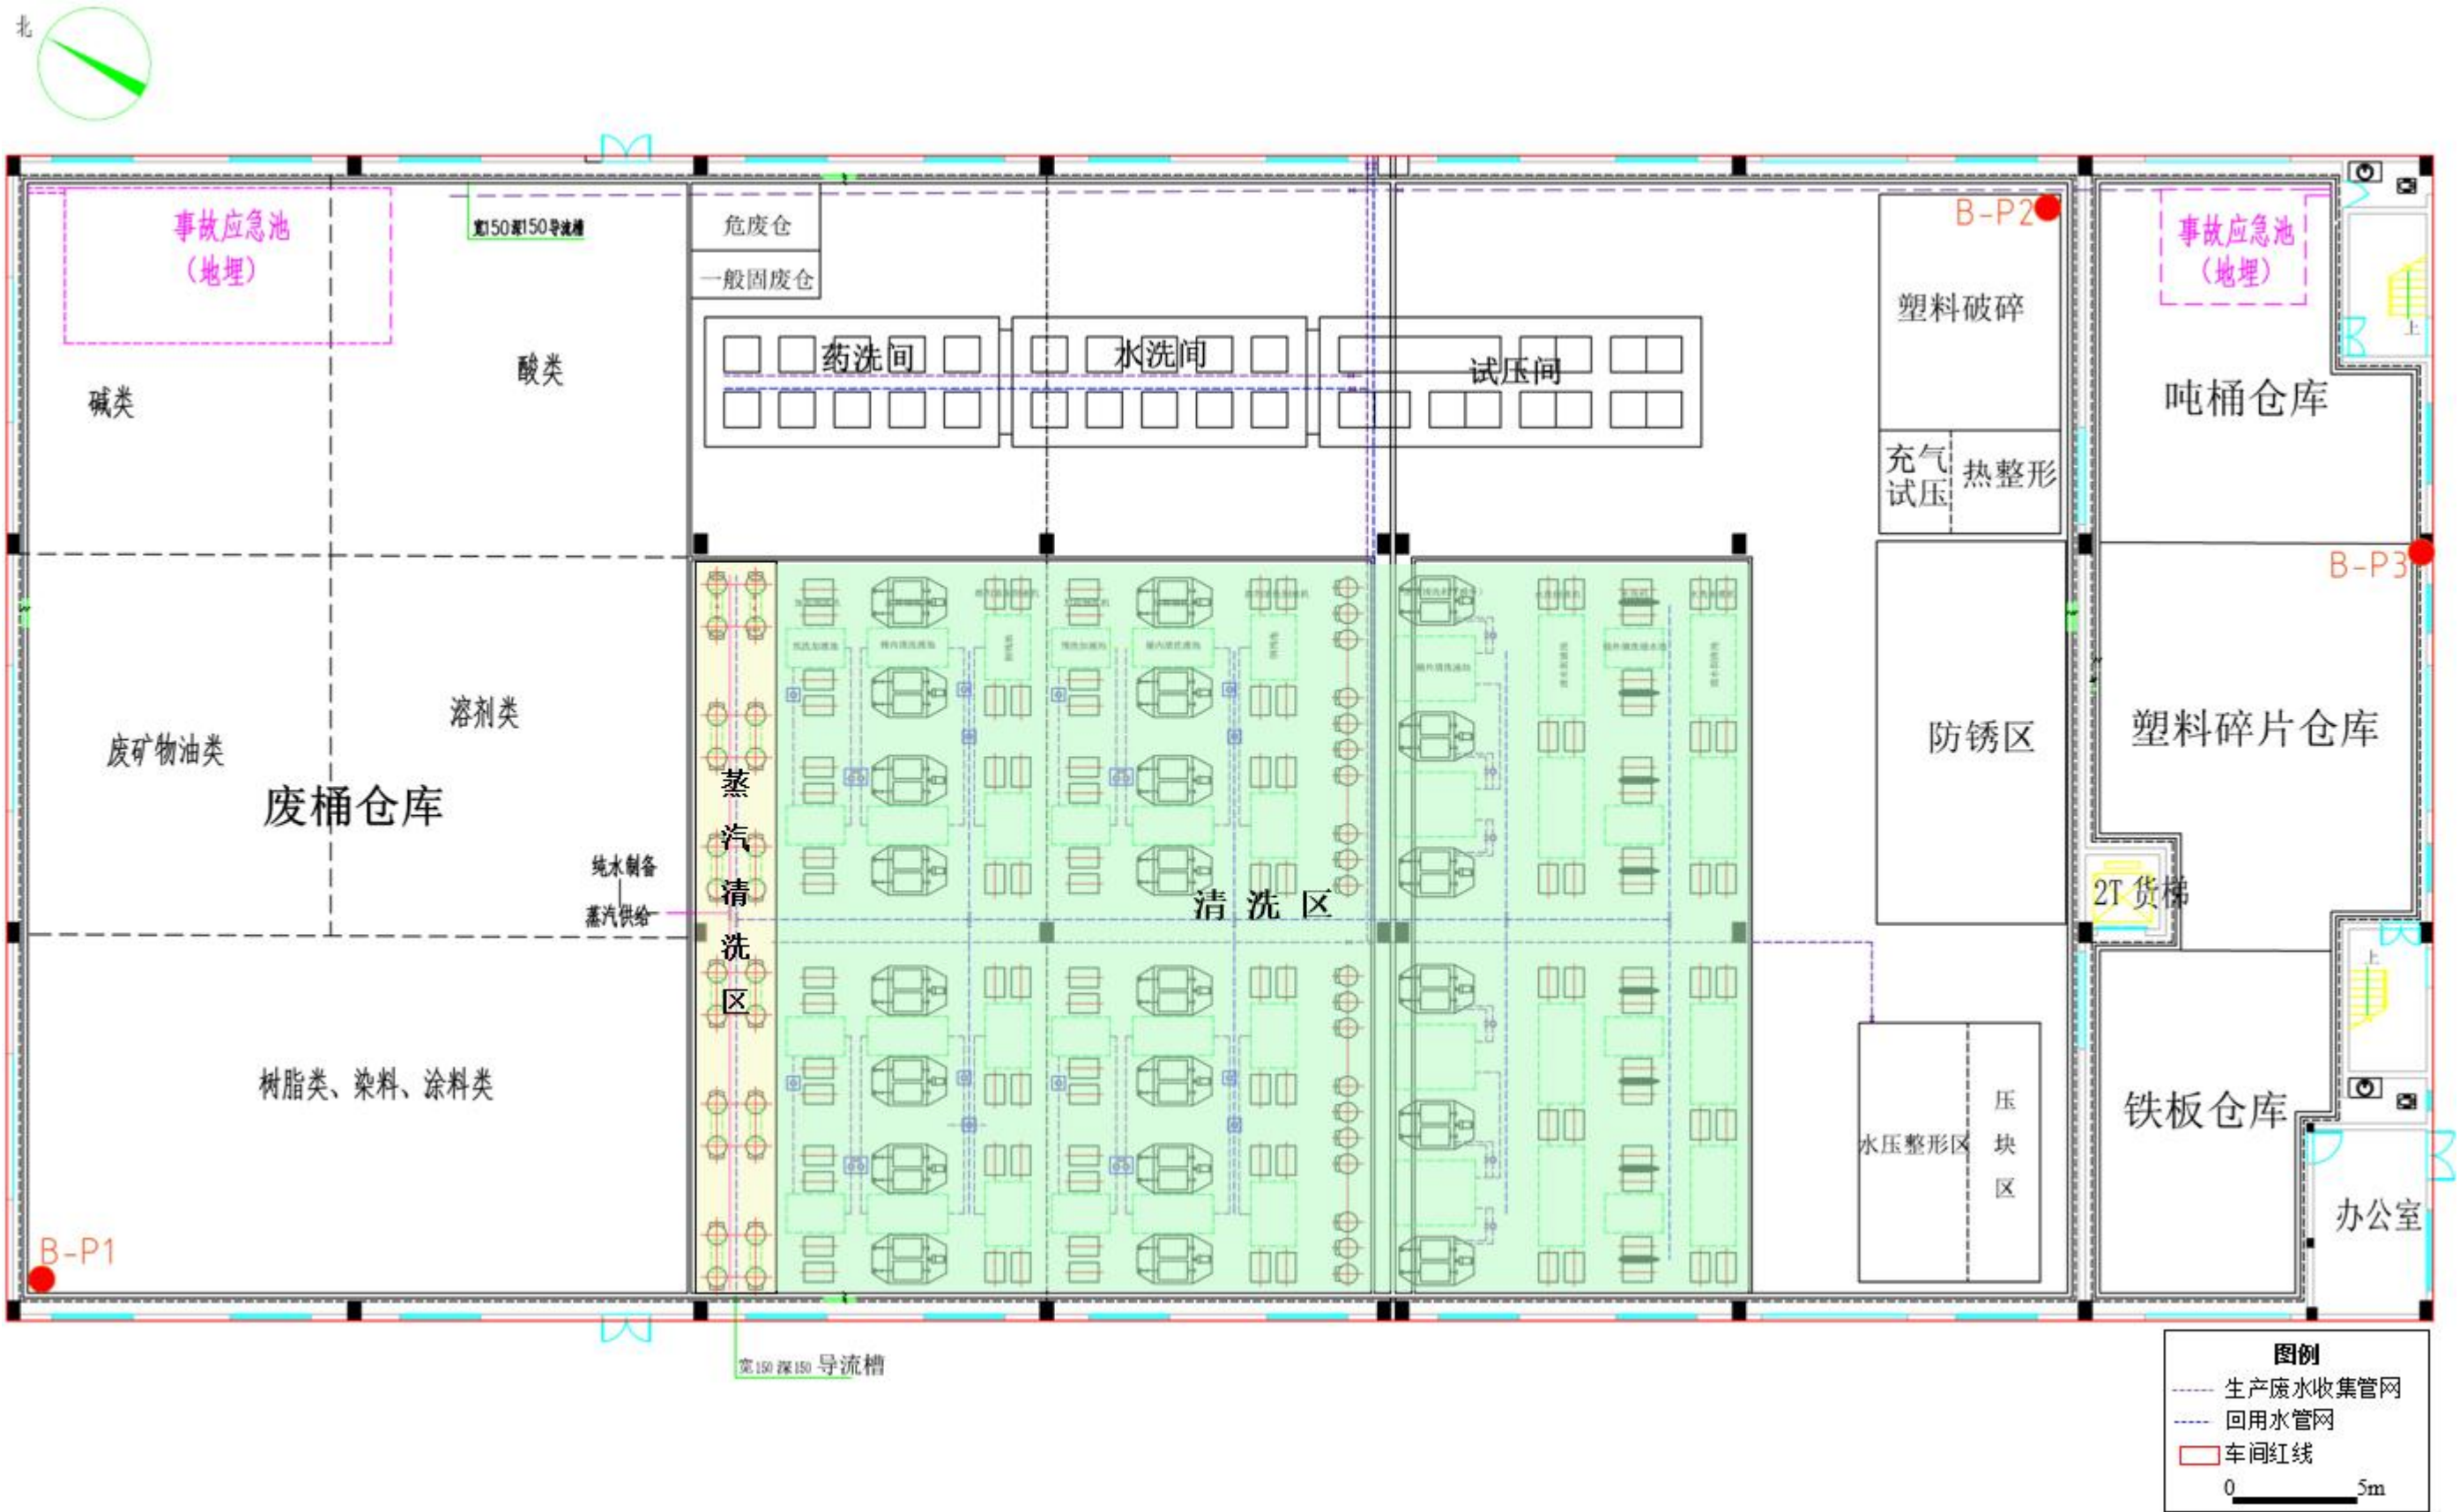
废包装桶处理车间平面布置图 (一层)
